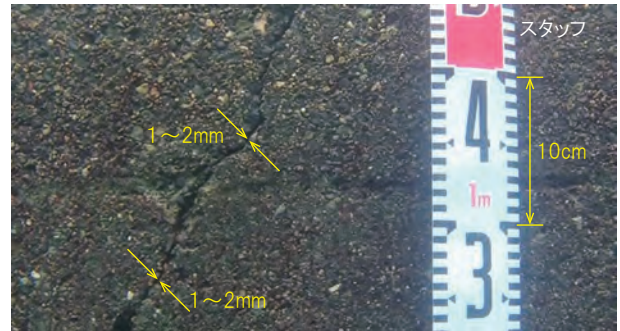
ひび割れ(上)と開孔(下)のサイズ計測
